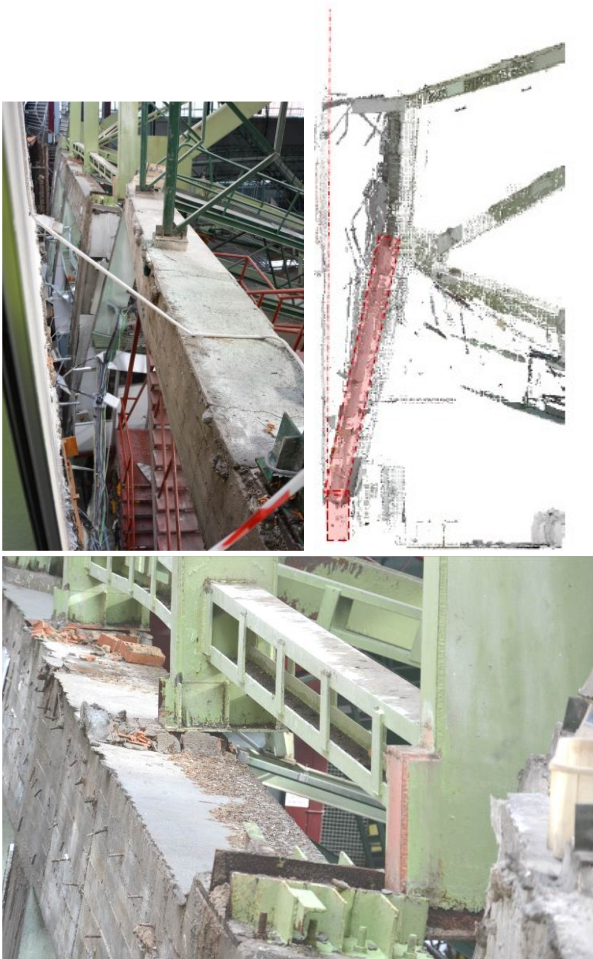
Arrastre de los pórticos de hormigón de apoyo de las celosías principales.
